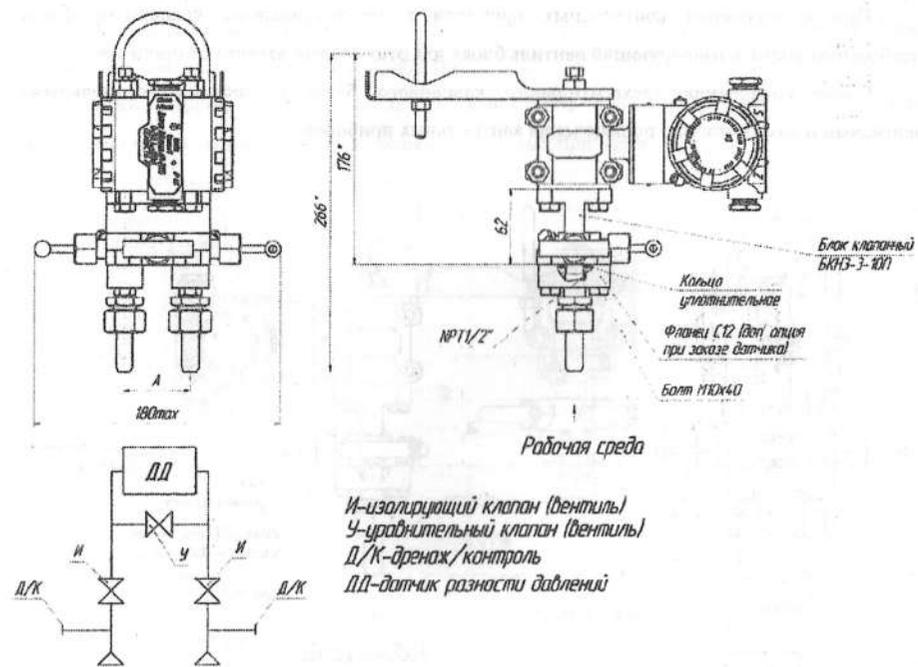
Схема монтажа блока клапанного БКНЗ-3-10
